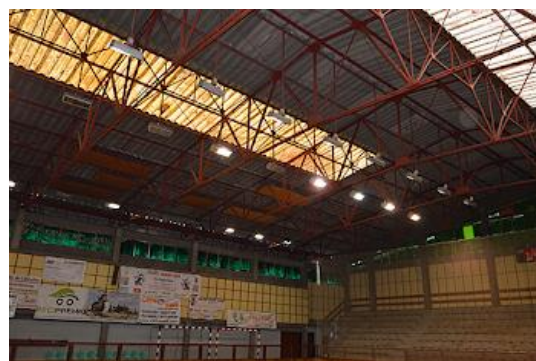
Cobertura chapa fibrocimento (Jornal das Caldas, 3 Abril 2014)
